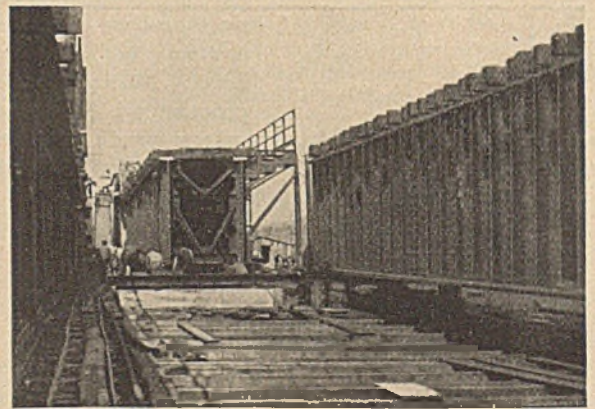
Altmühlbrücke bei Gstadt. Ein Überbau eingeschoben.
